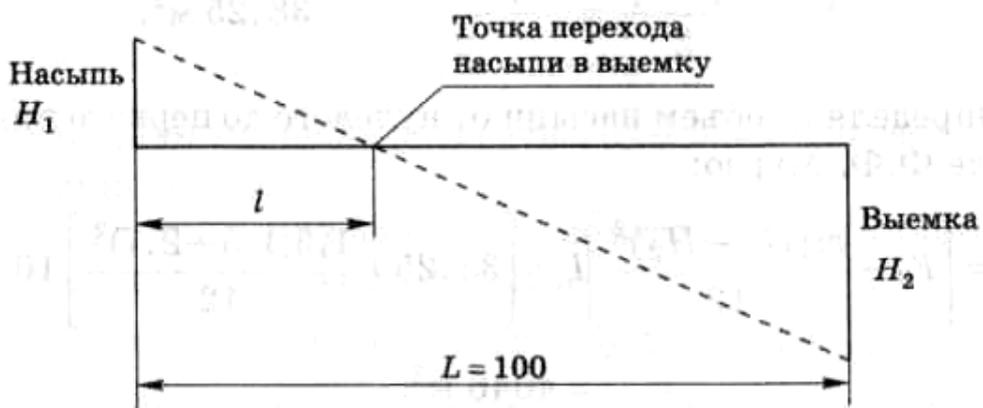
Расчетная схема определения перехода насыпи в выемку
